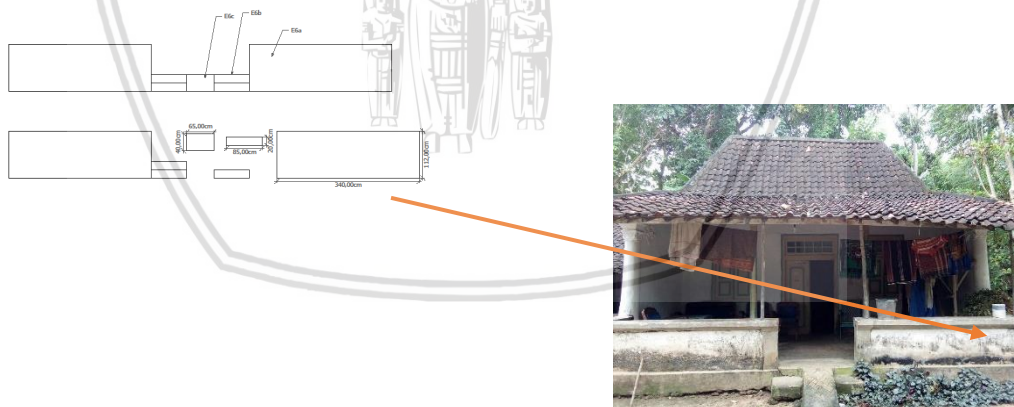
72 Dimensi kaki bangunan Desa Bungbungan
